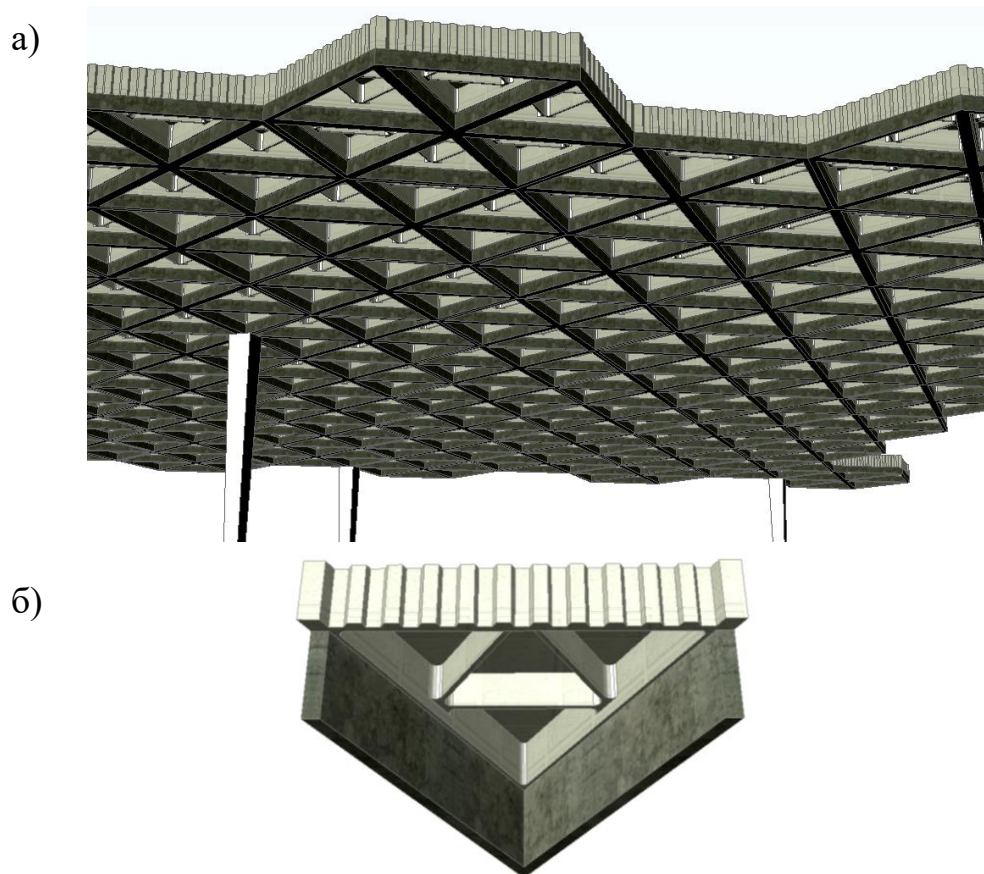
Багатопролітне збірно-монолітне часторебристе перекриття (а) з трикутними кесонами (б)
